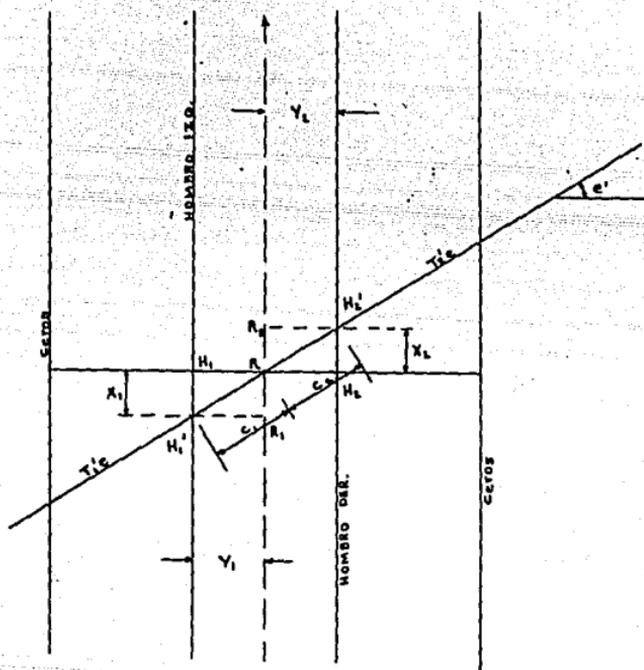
Elementos necesarios para el cálculo de la longitud de alcantarillas esviadas.
